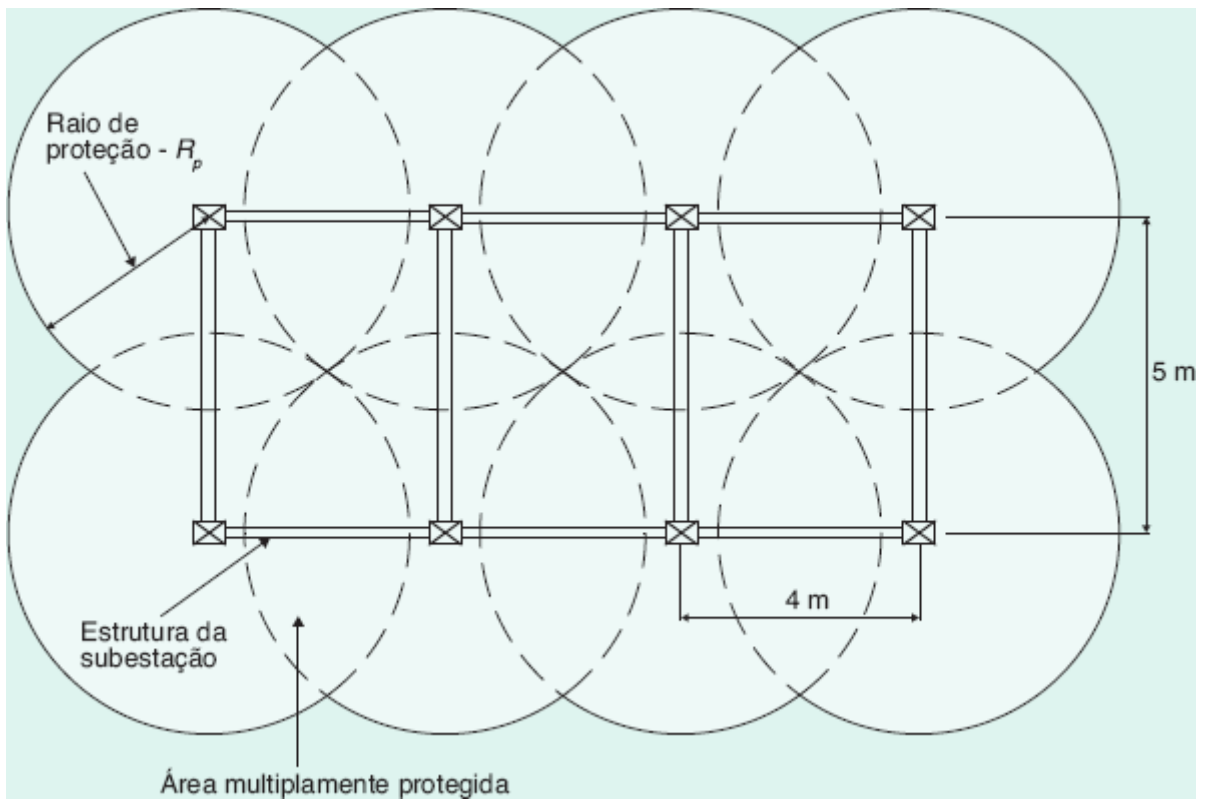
Raio de proteção de uma estrutura de subestação de instalação exterior.
